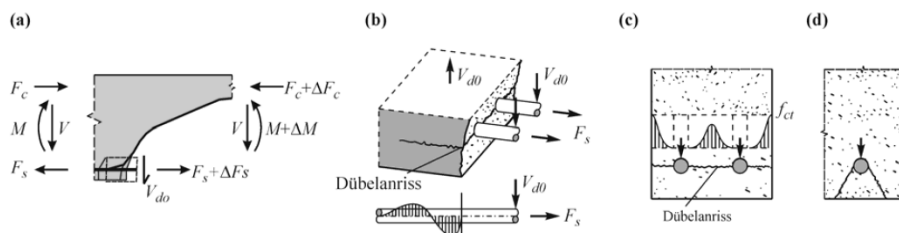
Dübeltragwirkung (Latte 2010): (a) Innere Kräfte am Biegeschubriss; (b) Abspaltung der Betondeckung; (c) Spannungen an der Rissfläche über der Balkenbreite; (d) Durchstanzen eines einzelnen Bewehrungsstabes
